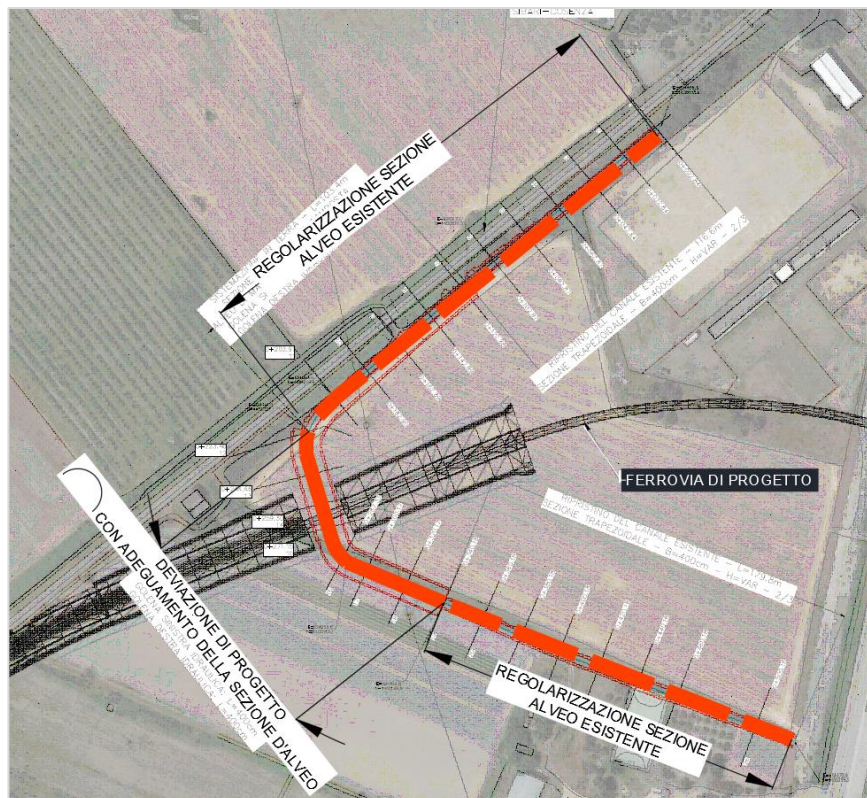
Stralcio planimetrico della sistemazione idraulica di progetto
